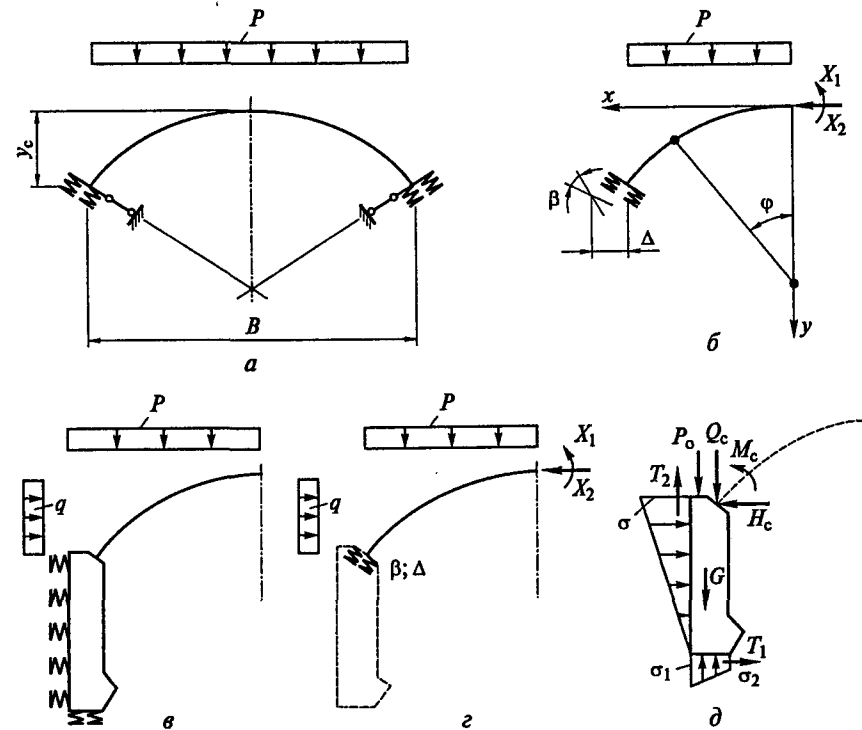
Схемы расчета пологого свода, опирающегося на грунт (а, б) и на вертикальные стены (в—д)
